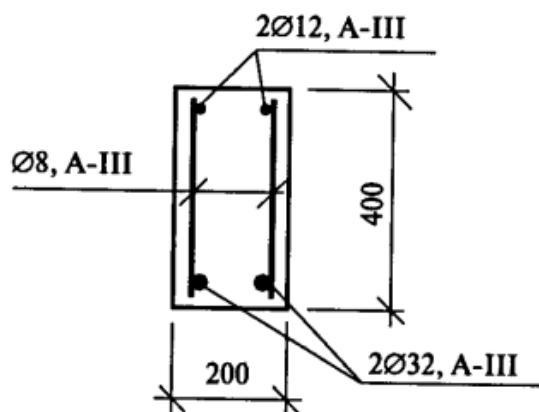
Армирование сечения балки – к примеру 7.9
